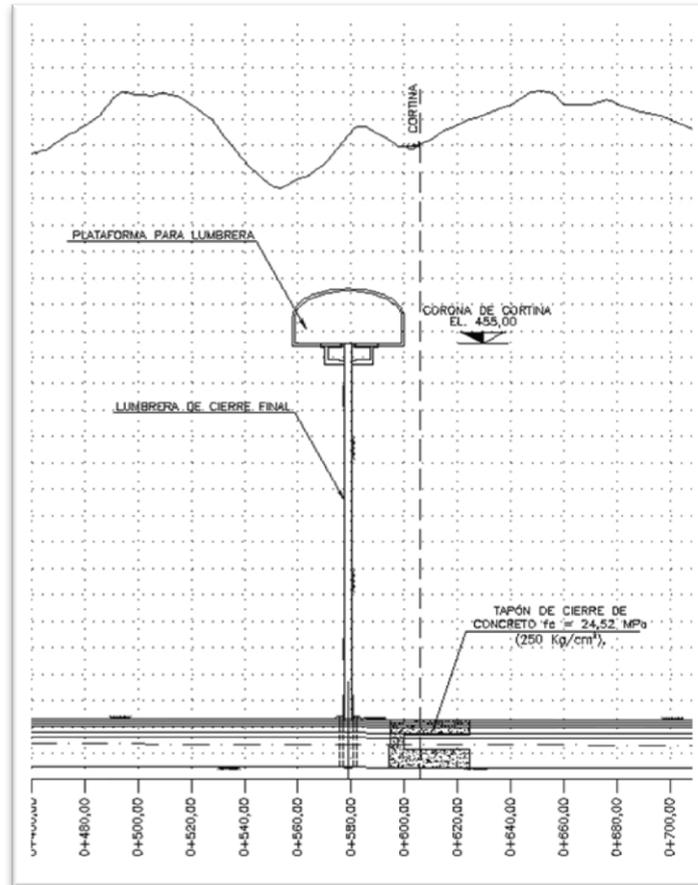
Perfil detalle de taponamiento y lumbrera de obturador –T3
